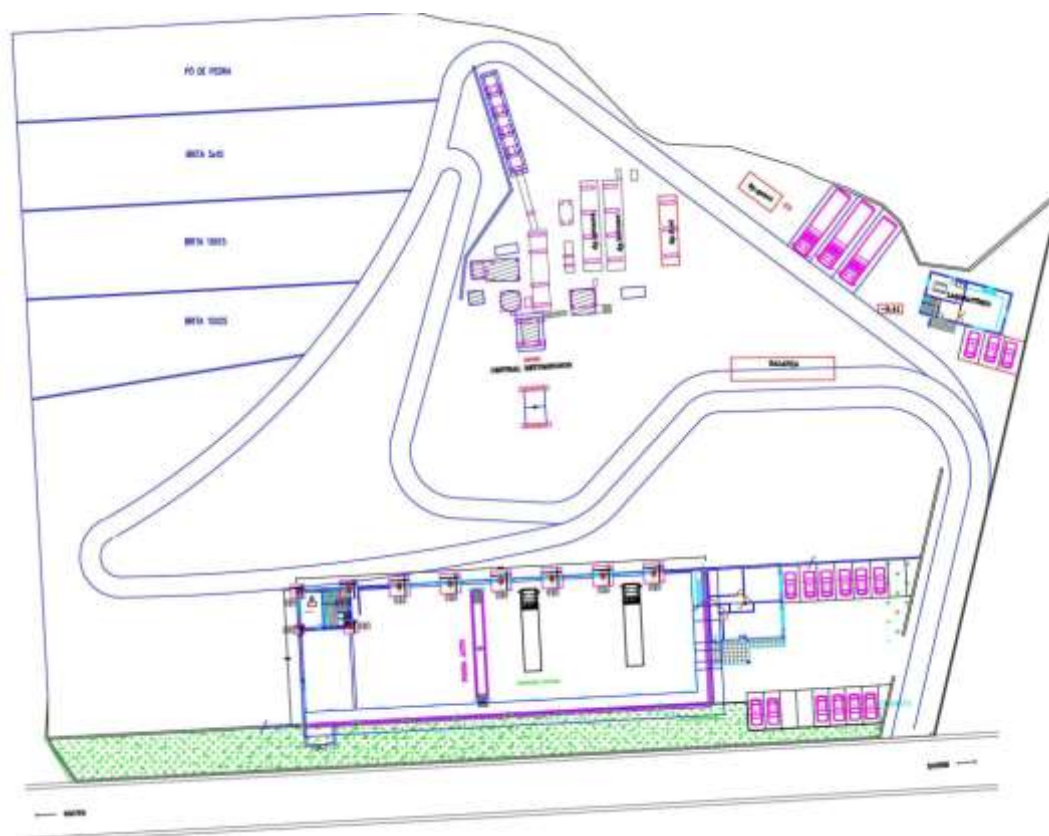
Planta do Estaleiro Central de Apoio à empreitada
